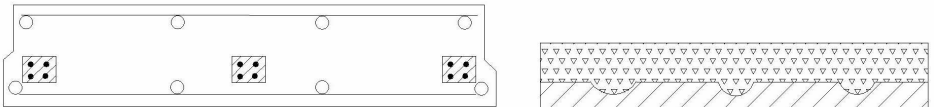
Армуння залізобетонних конструкцій попередньо напруженими елементами: а – типи перерізів попередньо напружених елементів; б – перерізи конструкцій, які армовані цими елементами.
